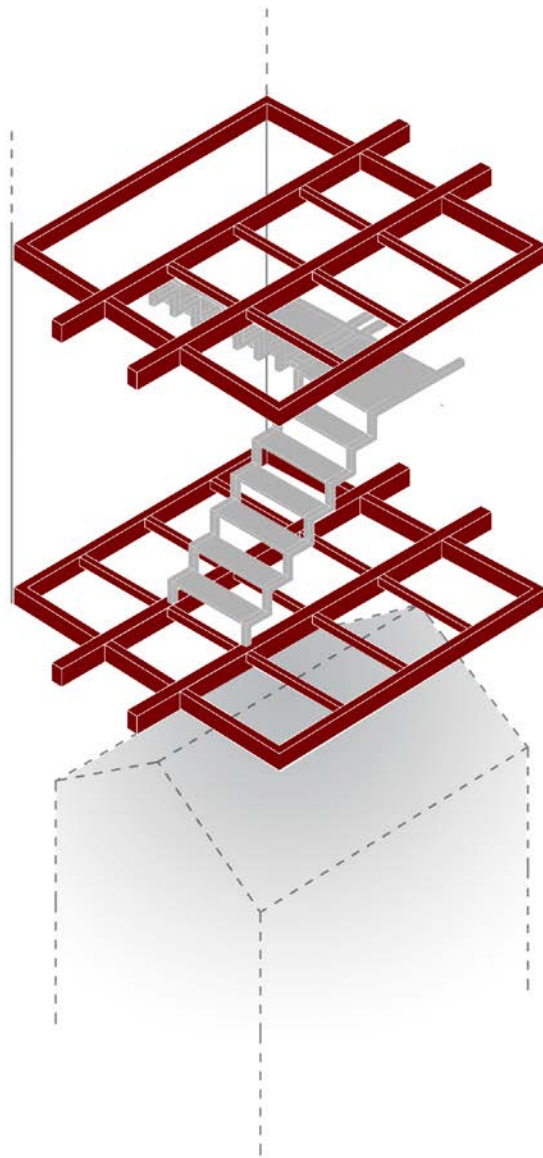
Concept strutturale: la struttura interna del mastio
